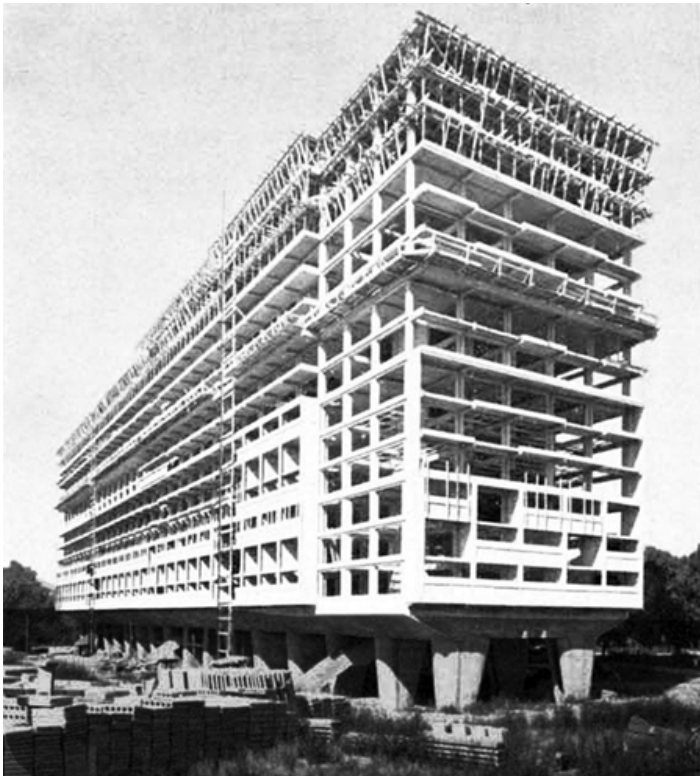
Construção da *Unité*, com estrutura de betão armado
